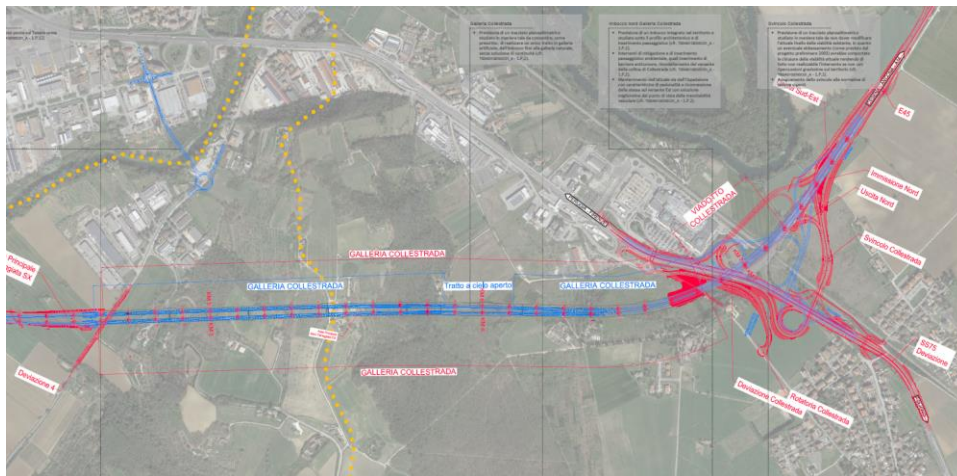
Confronto planimetrico (in rosso il progetto definitivo) – tav. 2 di 2
